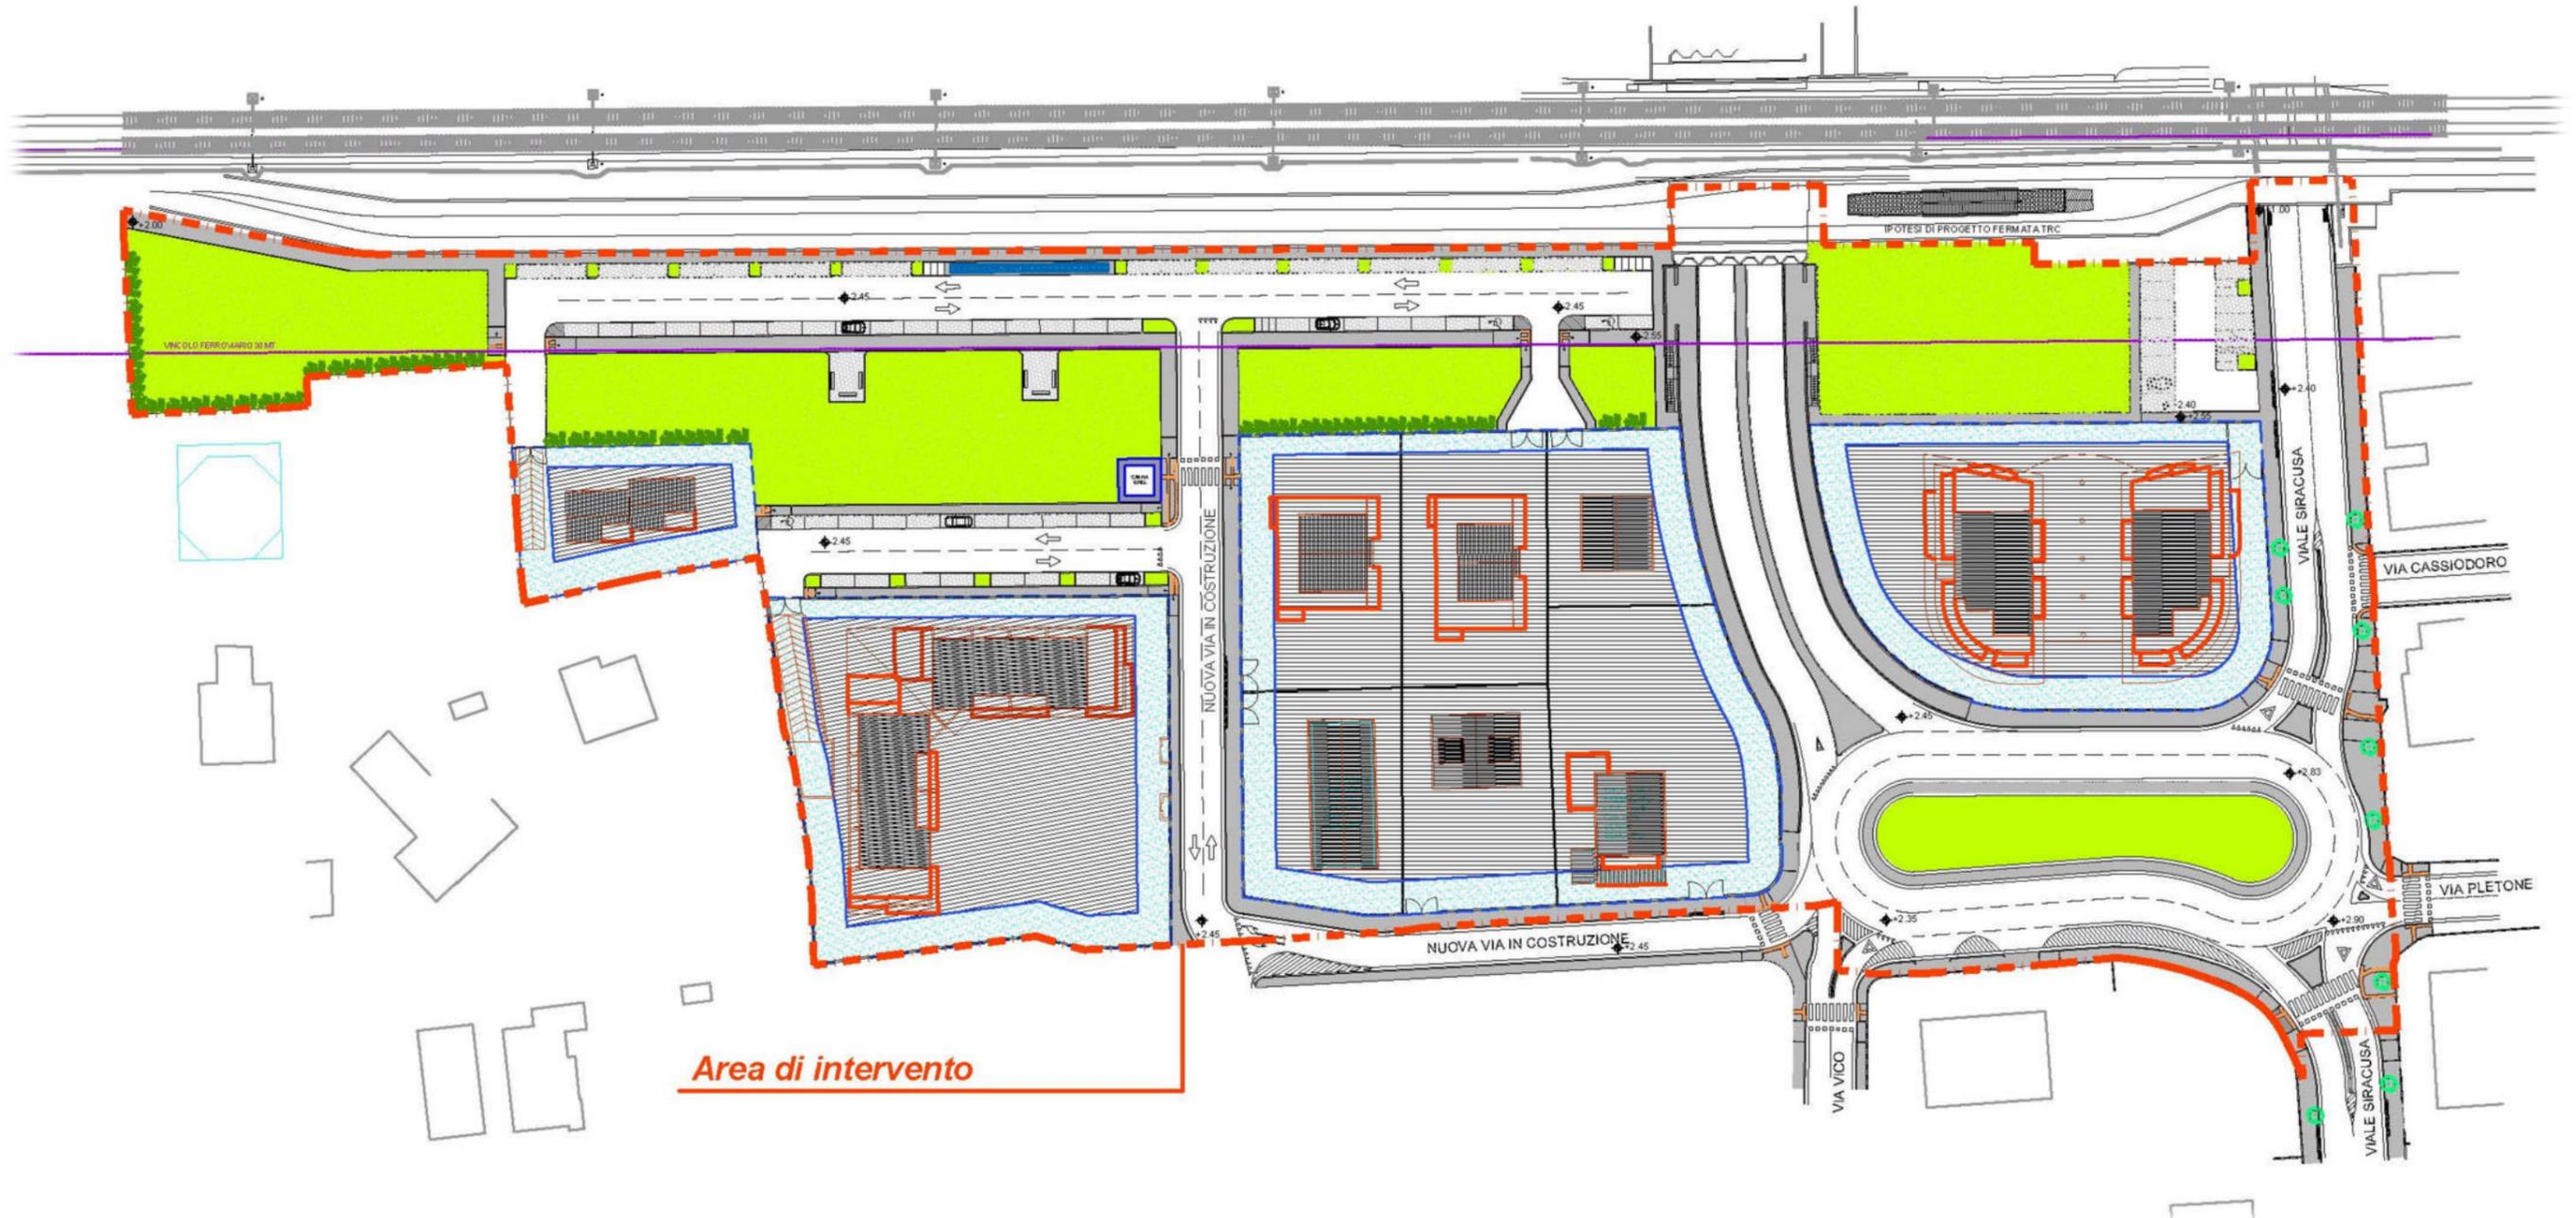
Planimetria del Piano Particolareggiato C13/26b approvata.
